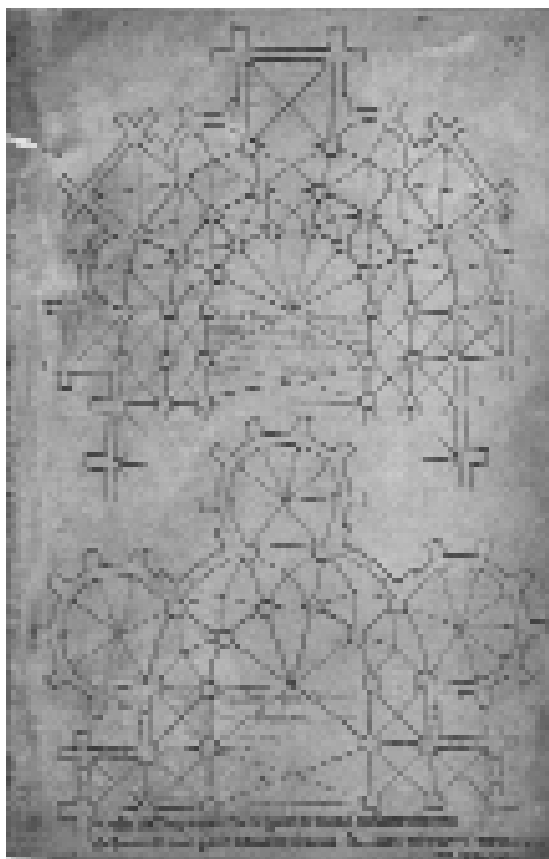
Villard de Honnecourt, Grundriss der Kathedrale von Meaux (unten); erfundener Grundriss (oben), um 1230
